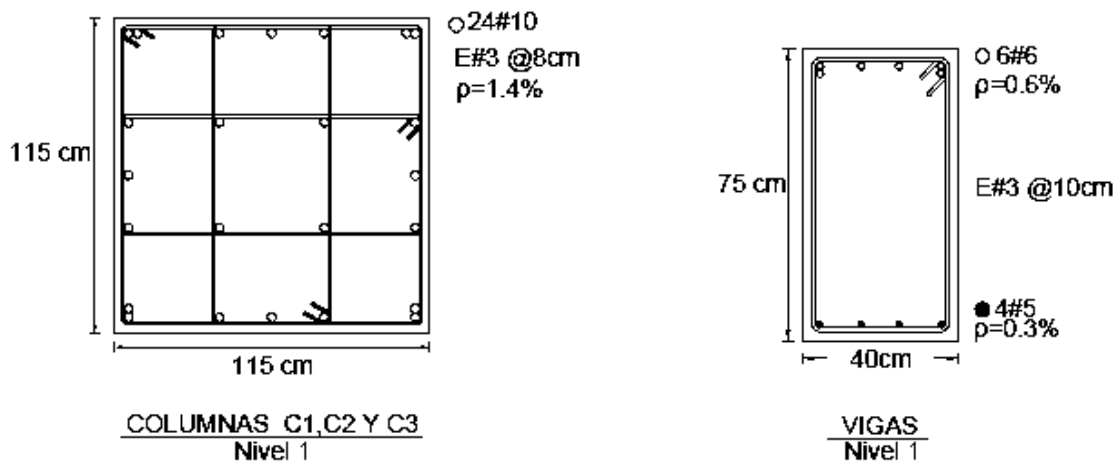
Armado de vigas y columnas diseñadas con las NTCC-17 para el edificio de 6 niveles cuyo sistema estructural consiste en marcos dúctiles
